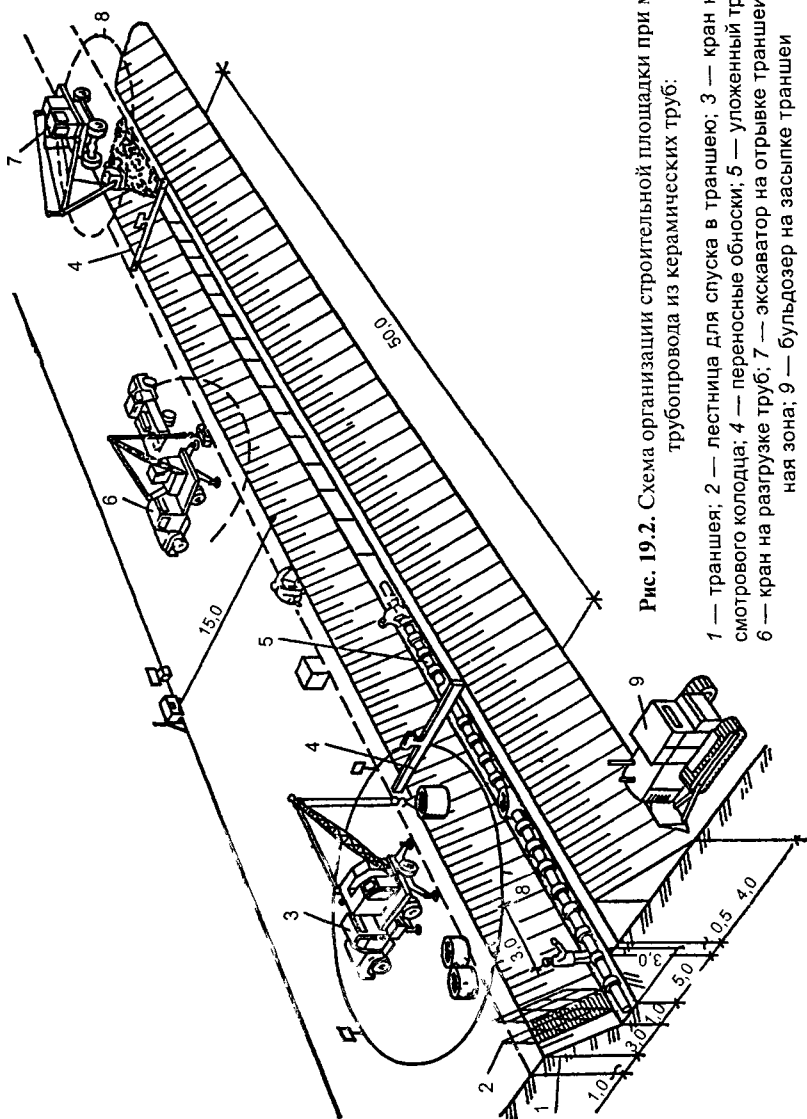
Схема организации строительной площадки при монтаже трубопровода из керамических труб:
